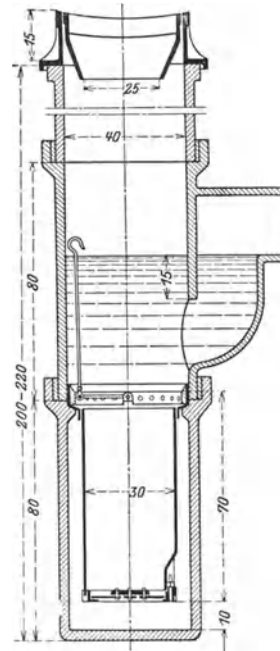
Straßeneinlauf, Bauart Geiger, mit Schlammfang- und Geruchsverschluß
